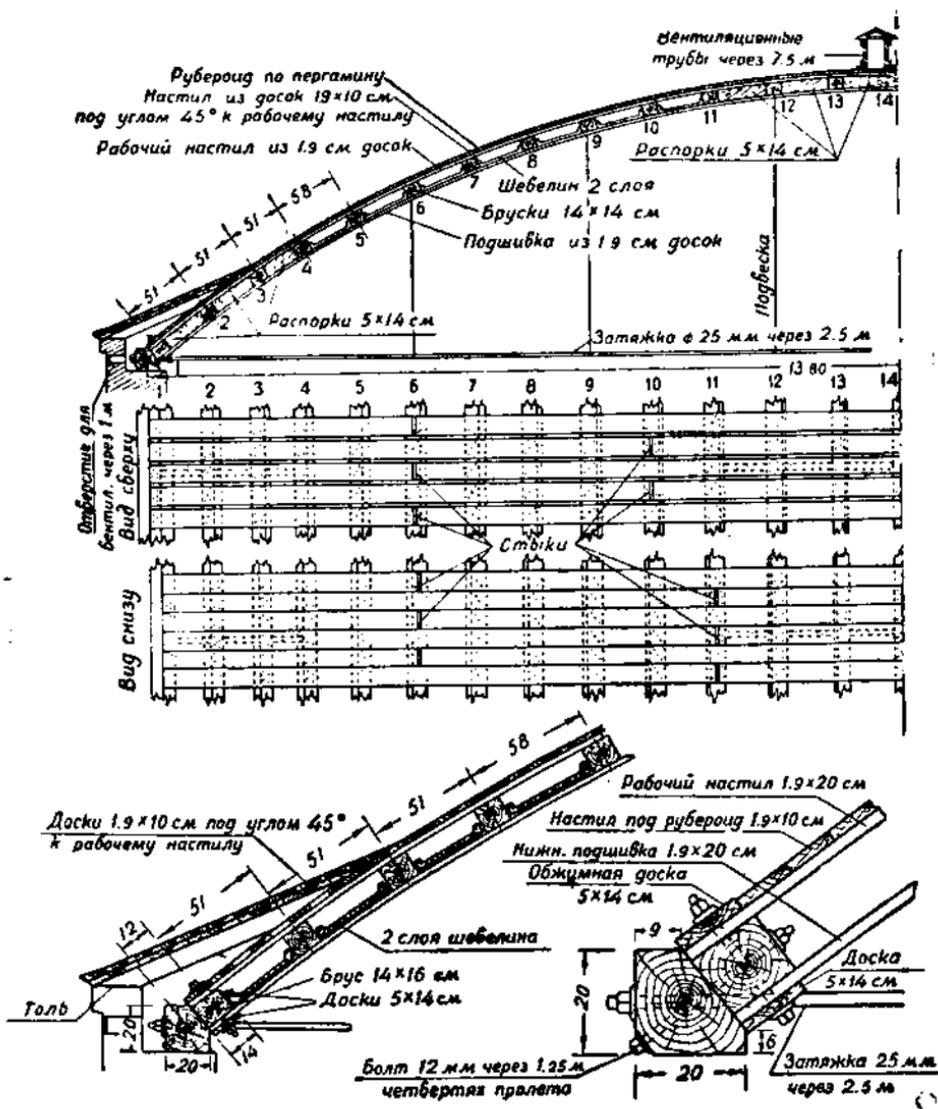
Двойной гнутый свод Шухова-Брода: план, разрезы и детали опорного узла.
